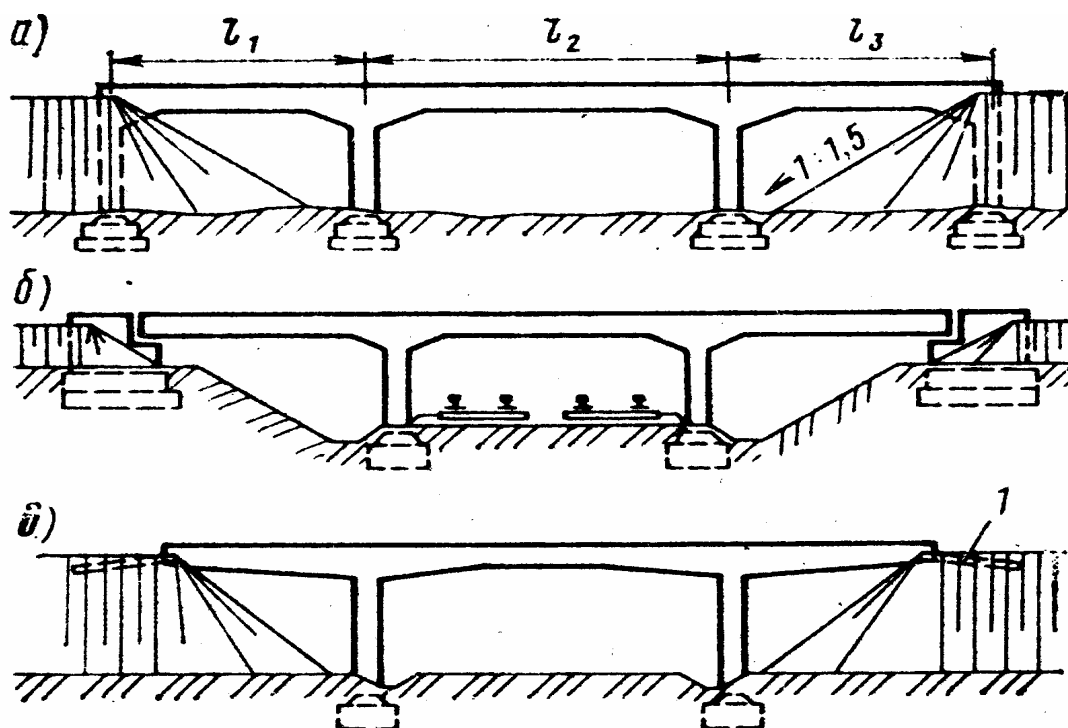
Схемы рамных мостов из ненапряженных железобетонных элементов
